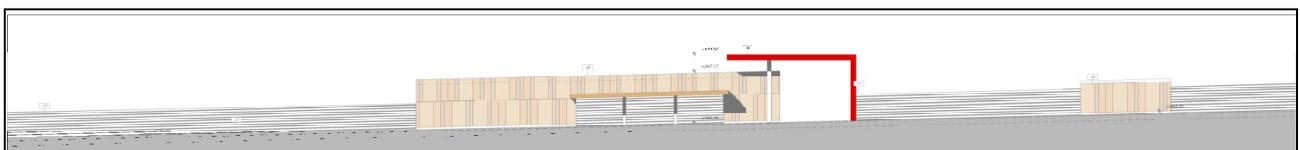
Prospetto pensilina lato strada Fermata Colajanni
